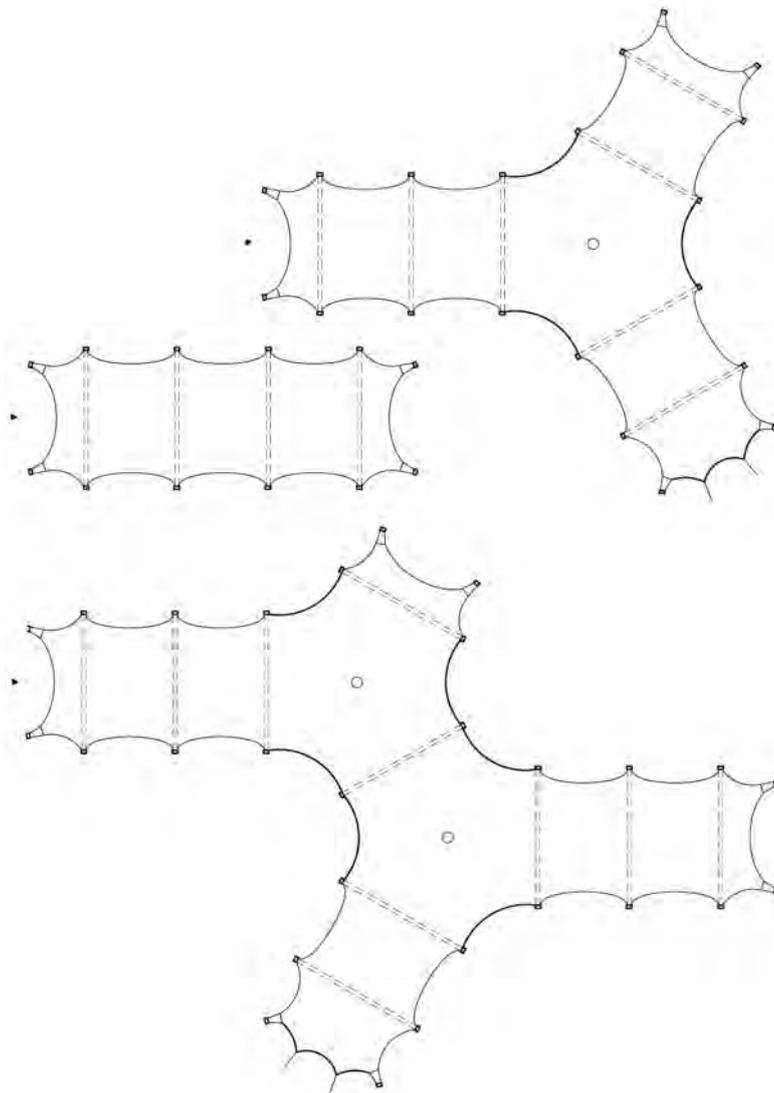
Grundrißvarianten für Membranbauten von Spann-Bau, drei Beispiele. Maßstab 1:1000. *Eigene Darstellung.
